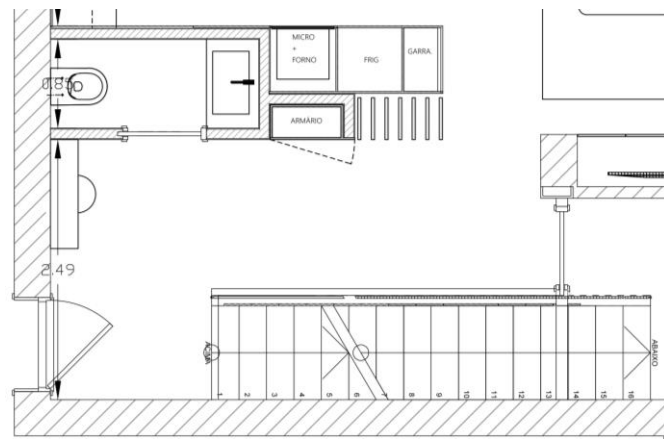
Pormenor Planta Hall de Entrada. Fonte: autora
